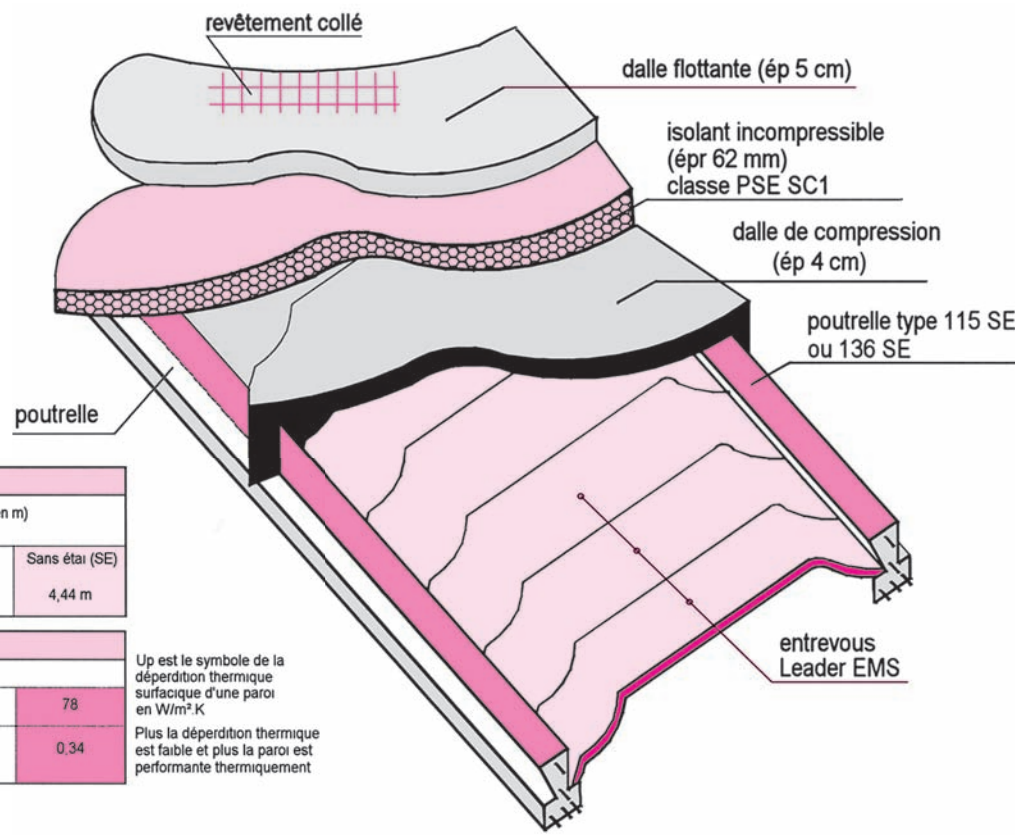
Plancher LEADER avec entrevous EMS + dalle flottante
